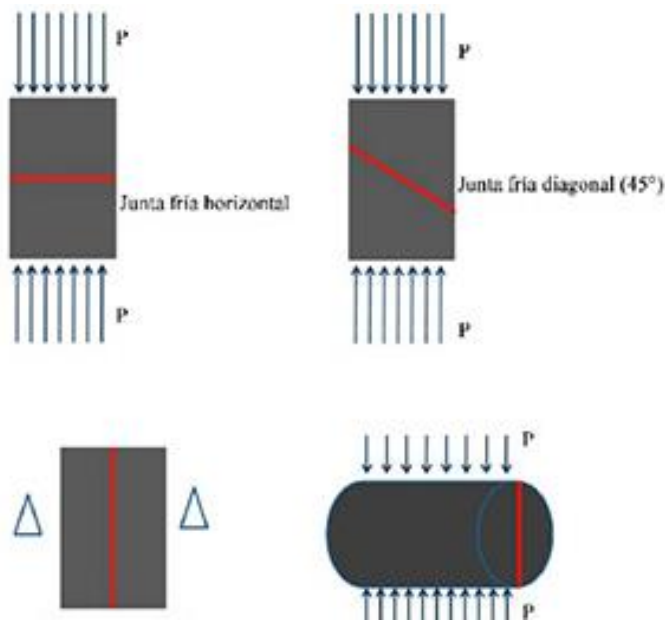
Junta fría (Comportamiento mecánico de juntas frías lisas de concreto, 2016)
